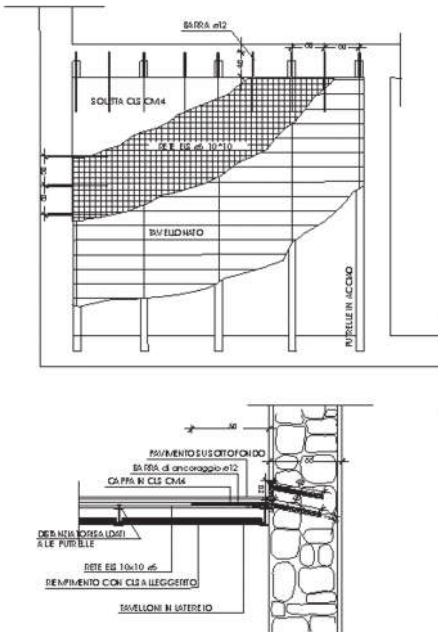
Realizzazione di irrigidimento di un solaio in putrelle e collegamento alle murature (1999).
